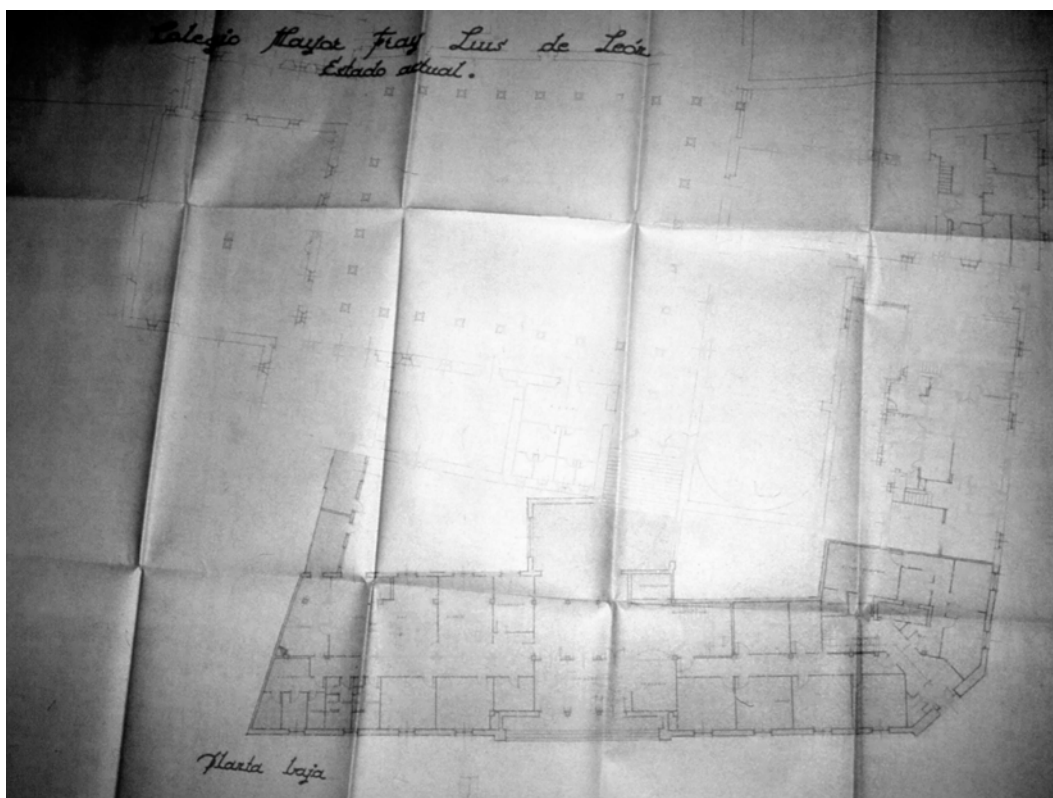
C. M. Fray Luis de León: estado de la planta baja (semisótano) en 1956.
